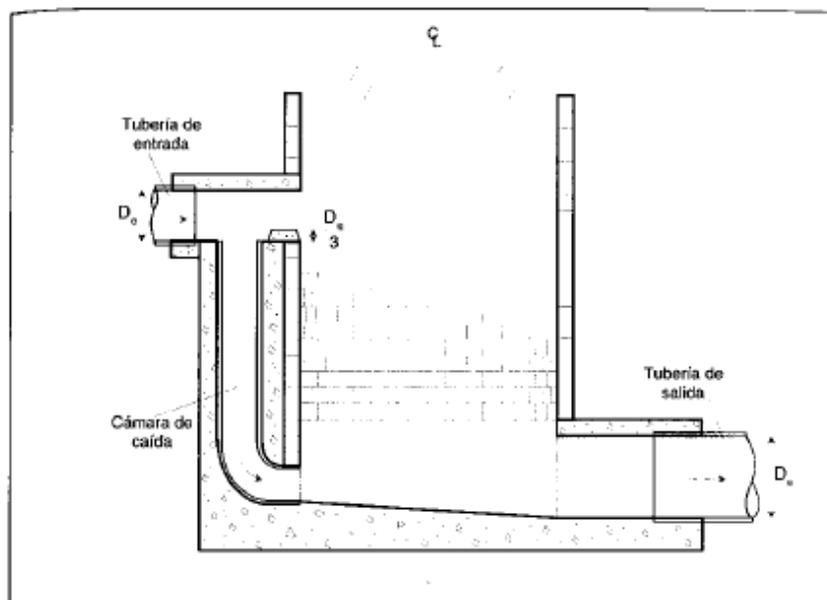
Cámara de caída. Adaptado de (Cualla, 2003).
